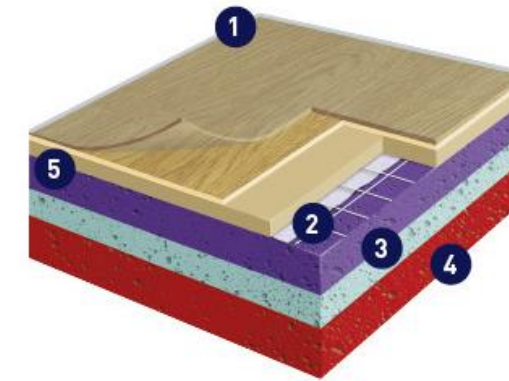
Pavimento técnico deportivo Taraflex Sport M Comfort (Gerflor).
